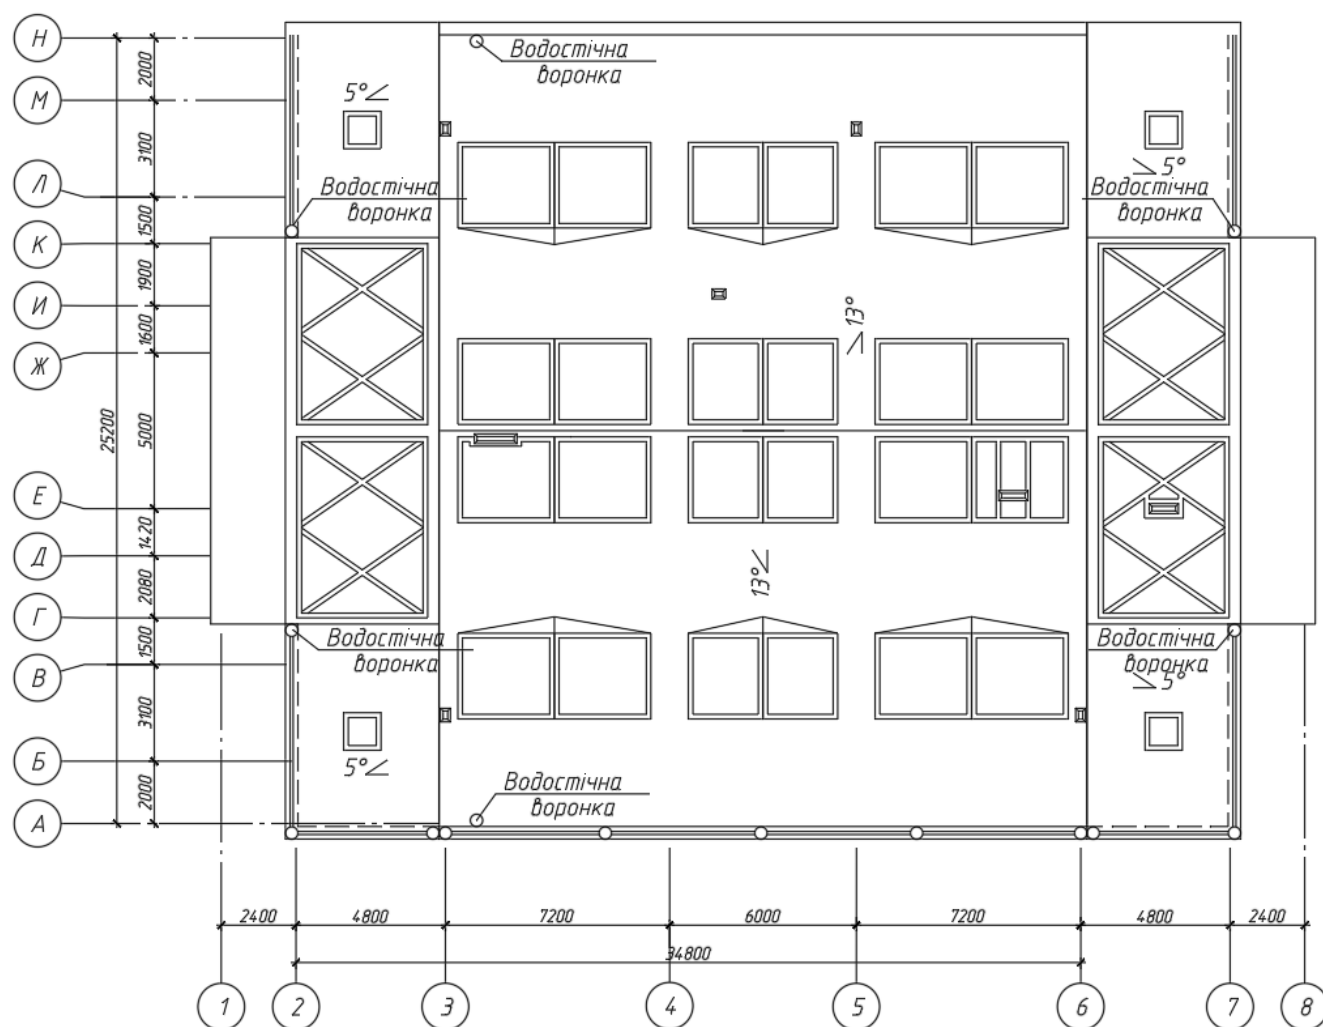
План покрівлі з розташування водоприймальних воронок
